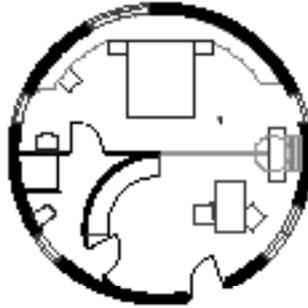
Axonometrie, Grundriss Varianten von Wohnungstyp 1
